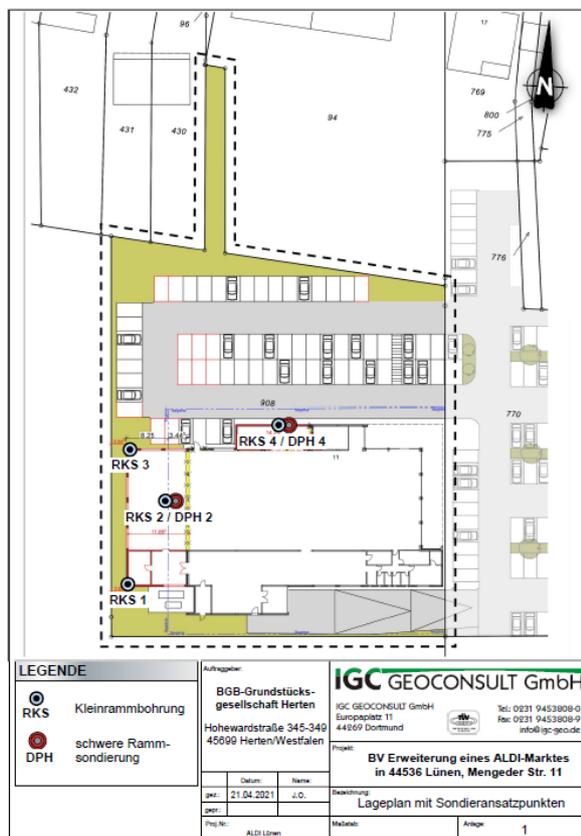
Lageplan Sondierungen (ICG Geoconsult GmbH, 12.05.2021)
